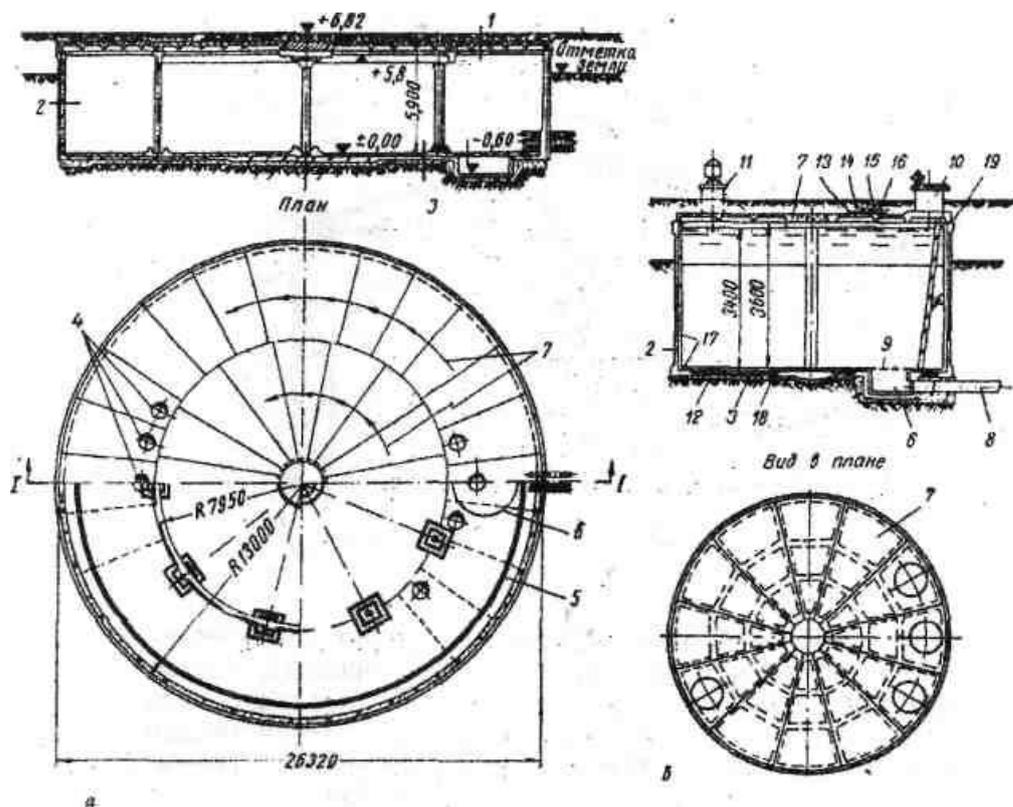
Монолитные цилиндрические железобетонные резервуары:
